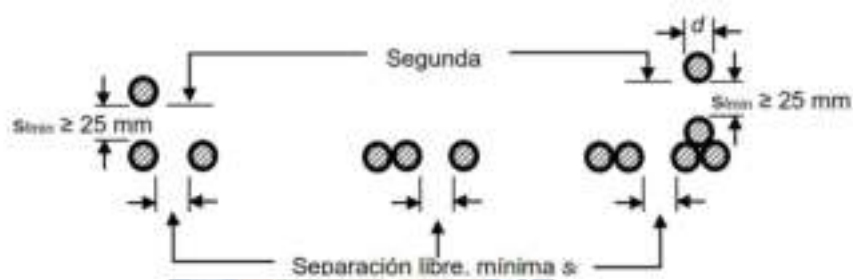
Separación libre mínima entre barras ubicados en una capa y separación libre entre capas de armaduras.
